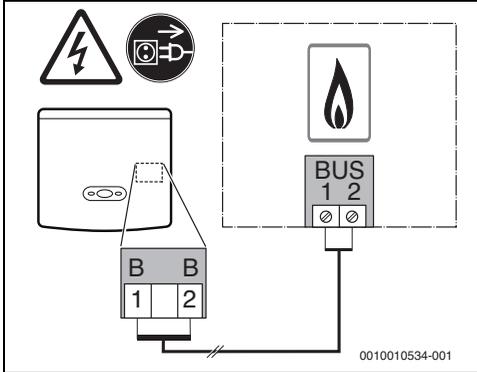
Anschluss des Funkmoduls an einem Wärmeerzeuger
